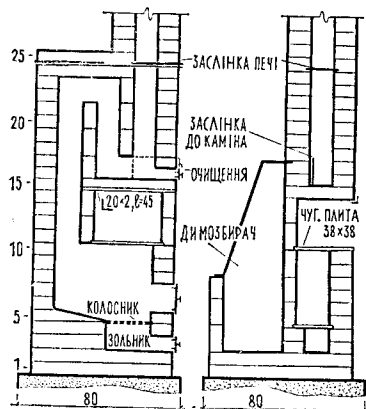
Вертикальні розрізи опалювально-варочної печі (вид спереду і збоку)
